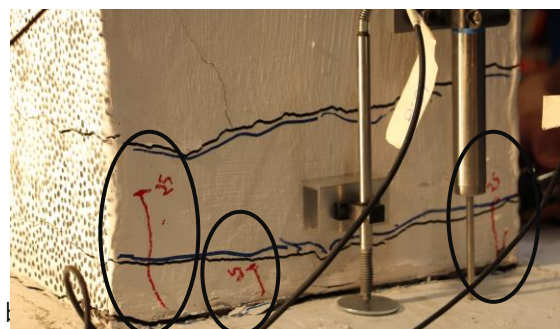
Fissures verticales de compression sur la face latérale gauche de la colonne C1A au LS25
